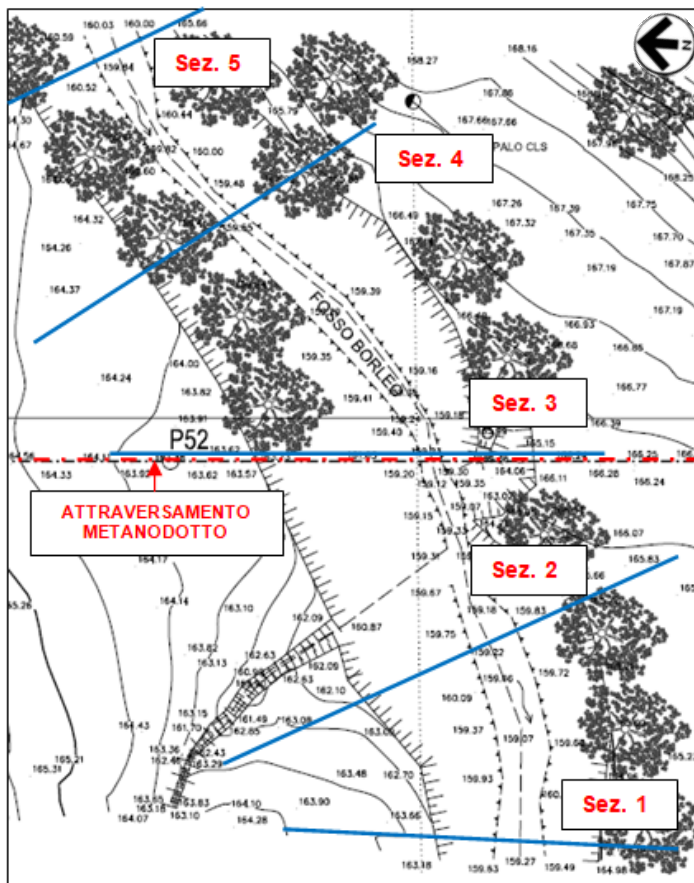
/A – Planimetria del tratto di corso modellato con riportate le sezioni
